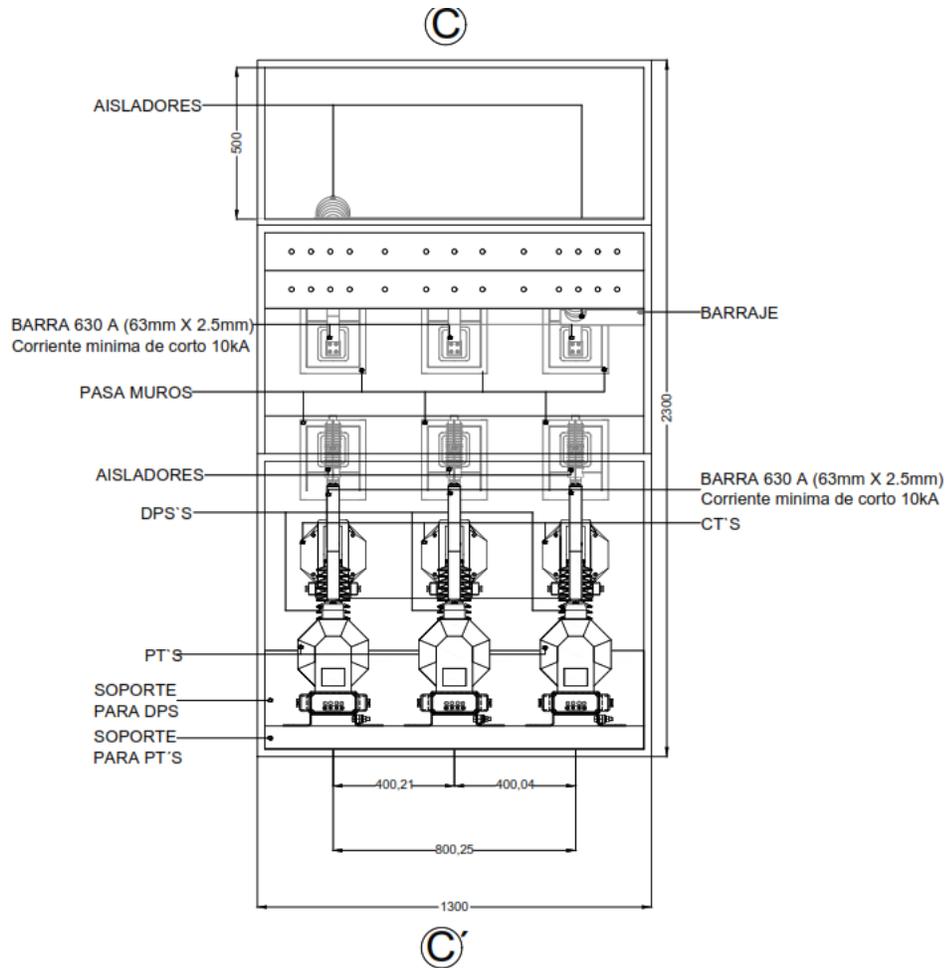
Plano mecánico de la celda de conexión – vista posterior interna corte C-C’.
